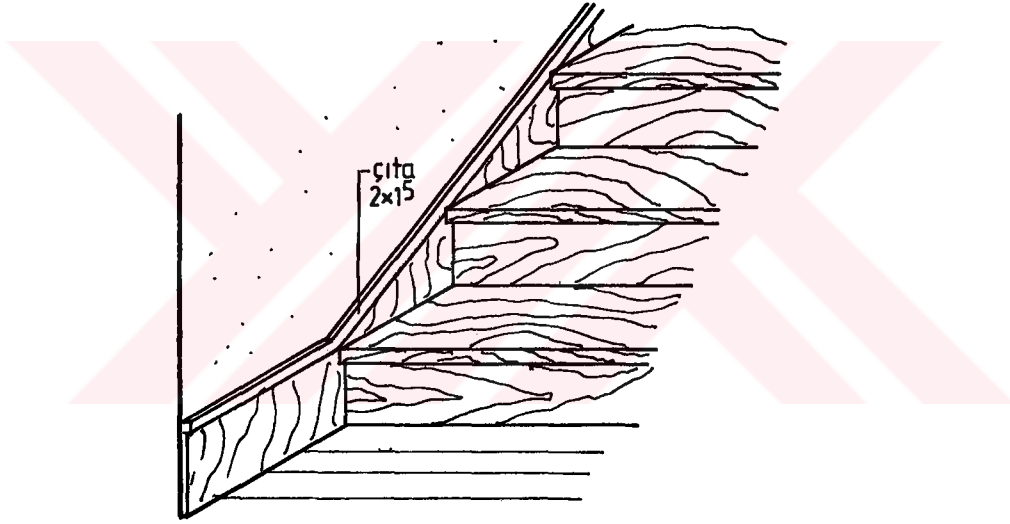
B tipi süpürgelik detayı örneđi.
